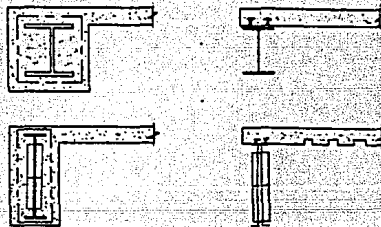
DETALLES DE PISO COMPUESTO.
